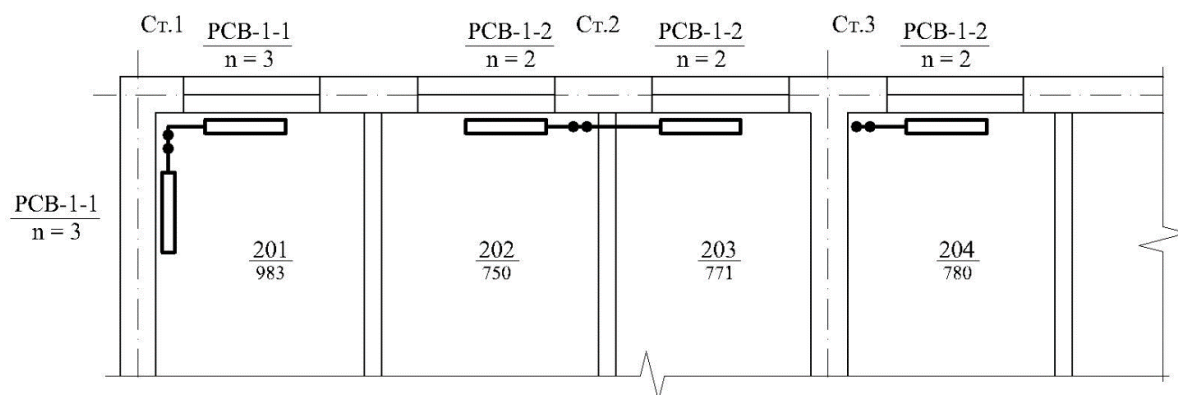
Варианты размещения отопительного оборудования на поэтажных планах здания
